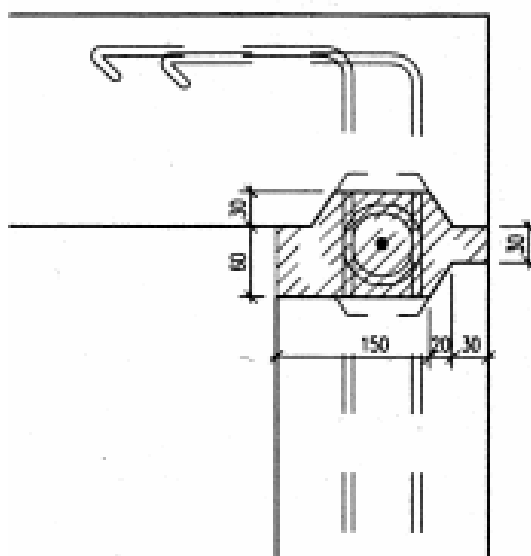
Armaduras com ganchos sobrepostos na junta de ligação
